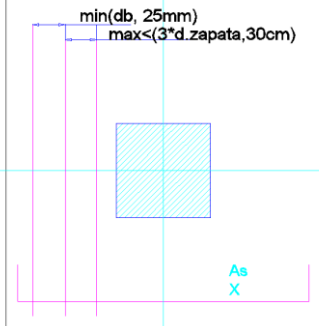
Viga Corrida de cimentación sobre zócalo de hormigón Ciclópeo
